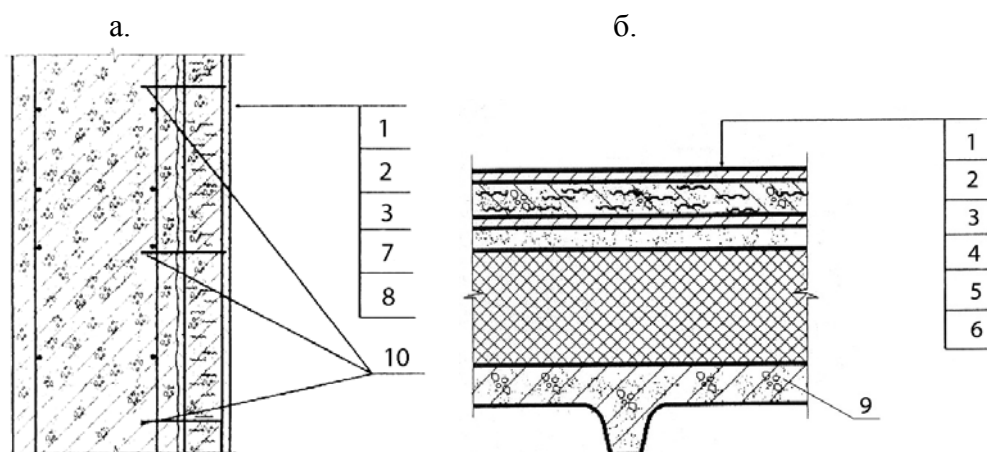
Примеры применения торкрет-фибробетонных покрытий в вертикальном (стена силоса – а) и горизонтальном (кровля – б) исполнениях
